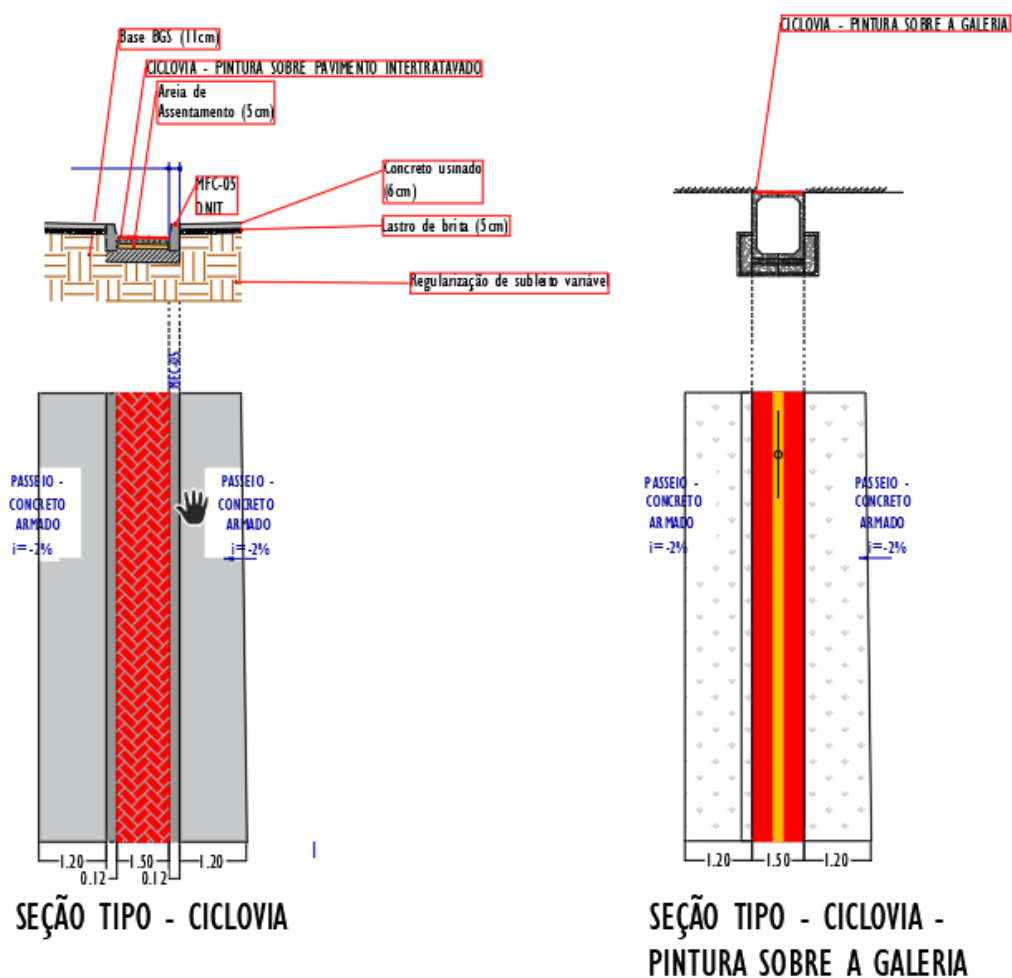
SEÇÃO TÍPICA DE PAVIMENTO - PARQUE LINEAR
